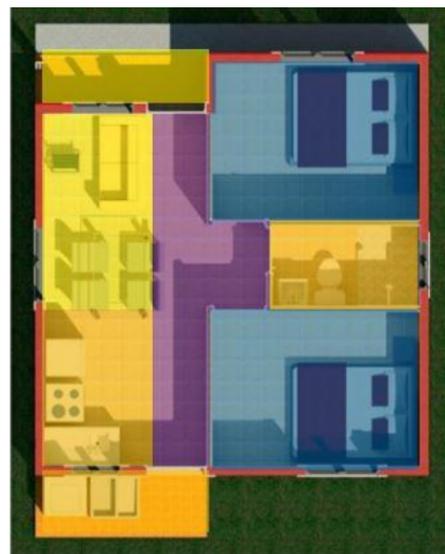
Planta Arquitectónica Modelo Malaquita
